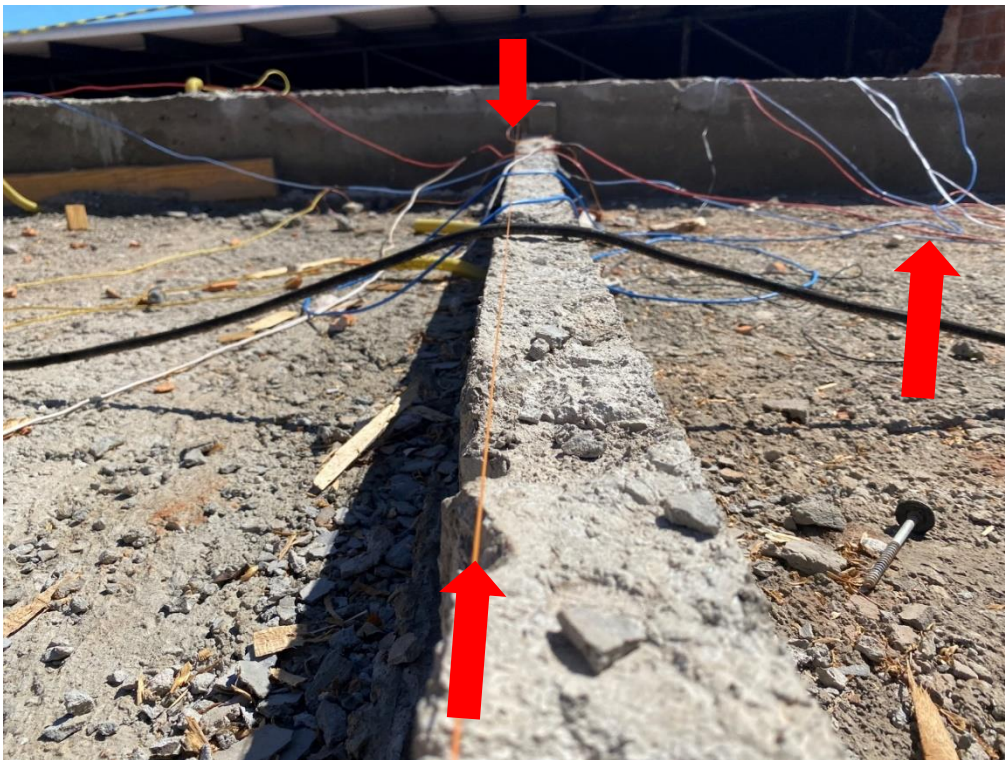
Vista da viga, detalhes de argamassa para correção/vedação das armaduras.
